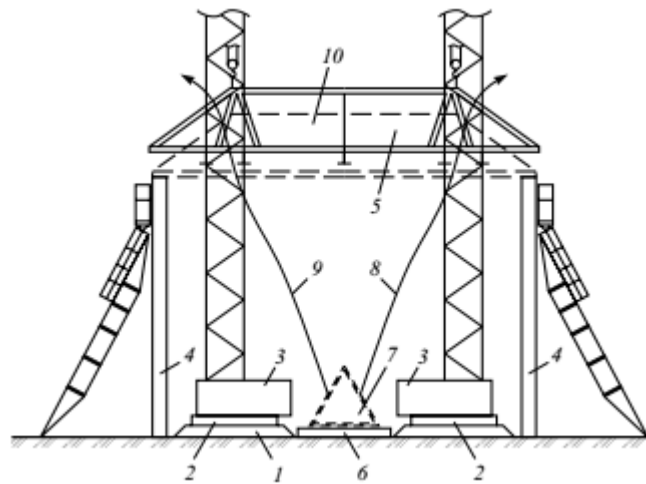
Монтаж блока балки двома кранами СКР-1500:
